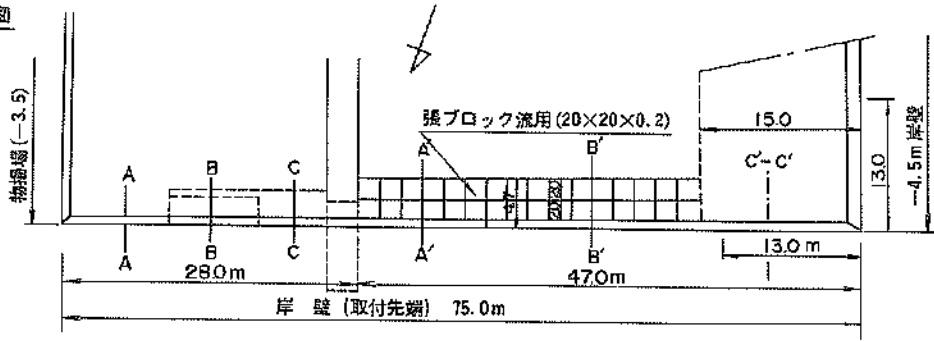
平面図・縦断面図・標準断面図 (①中央埠頭岸壁取付先端部 東側)
